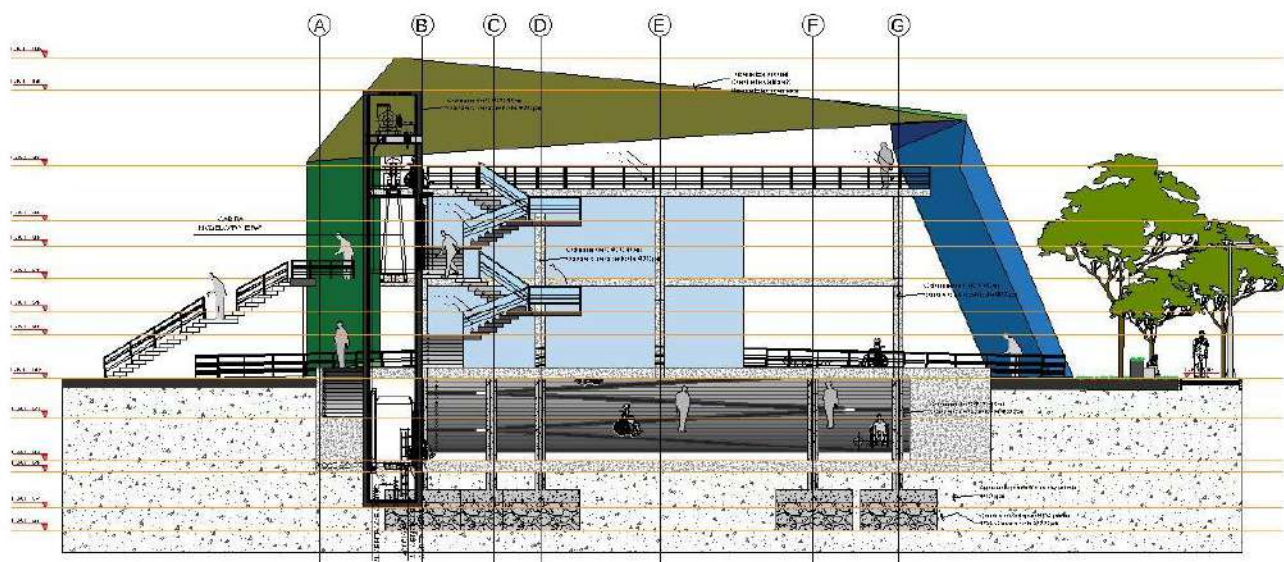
Sección arquitectónica longitudinal, edificio lúdico. Fuente: Elaboración propia 2021.
